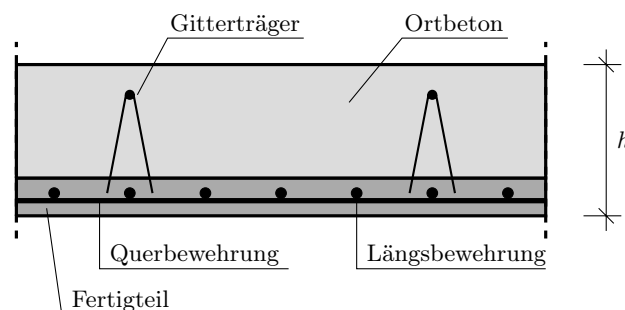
Querschnitt einer nachträglich mit Ortbeton ergänzten Teilfertigdecke
